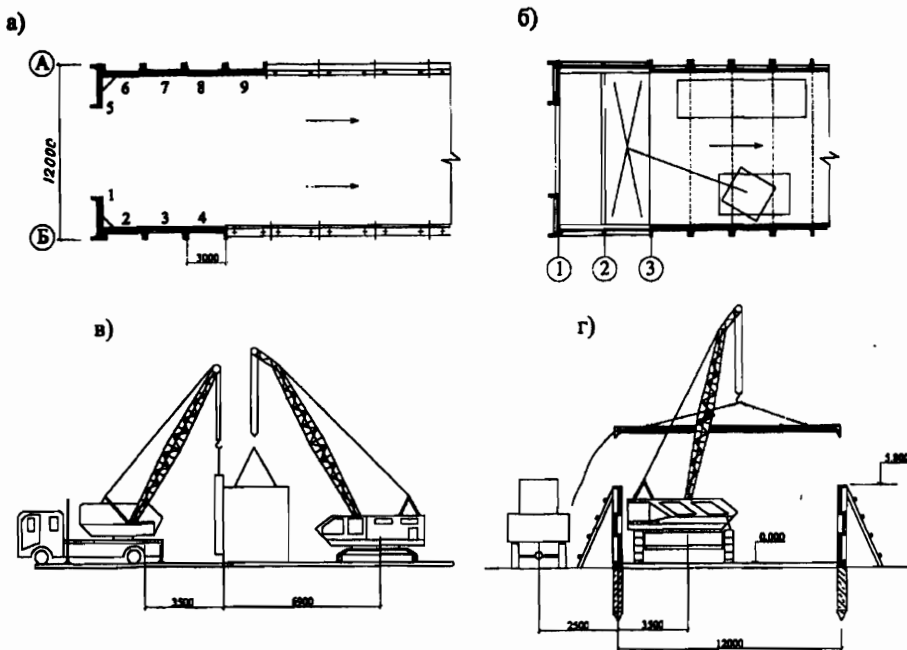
Технологические схемы монтажа однопролетного здания: а - монтаж наружных стен; б - монтаж покрытия и фризových панелей; в, г - технологические схемы монтажа наружных панелей и панелей покрытия
